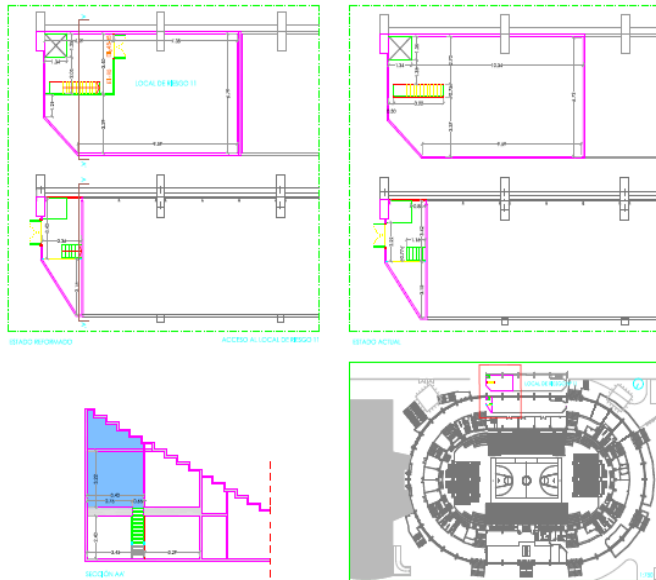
Plano Planta intervención en fachada. Plano Planta 9.
